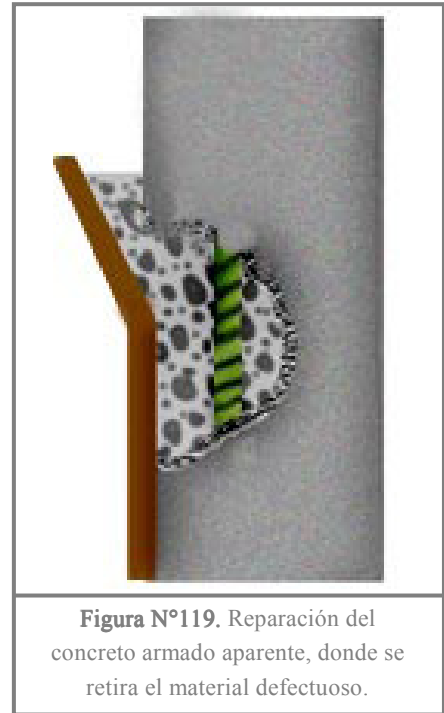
Reparación del concreto armado aparente, donde se retira el material defectuoso.
